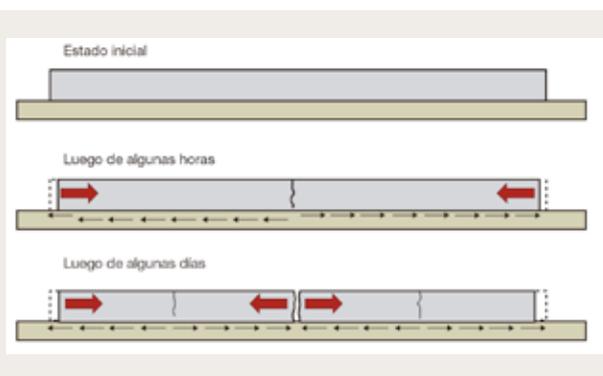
Efecto de la contracción restringida por la subbase o base sobre el patrón de fisuración de las losas de pavimento.
